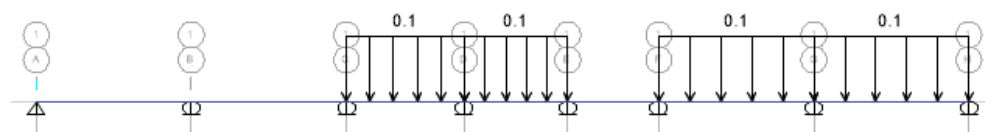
Carga viva distribuida en vigueta de losa aligerada – Damero 5
